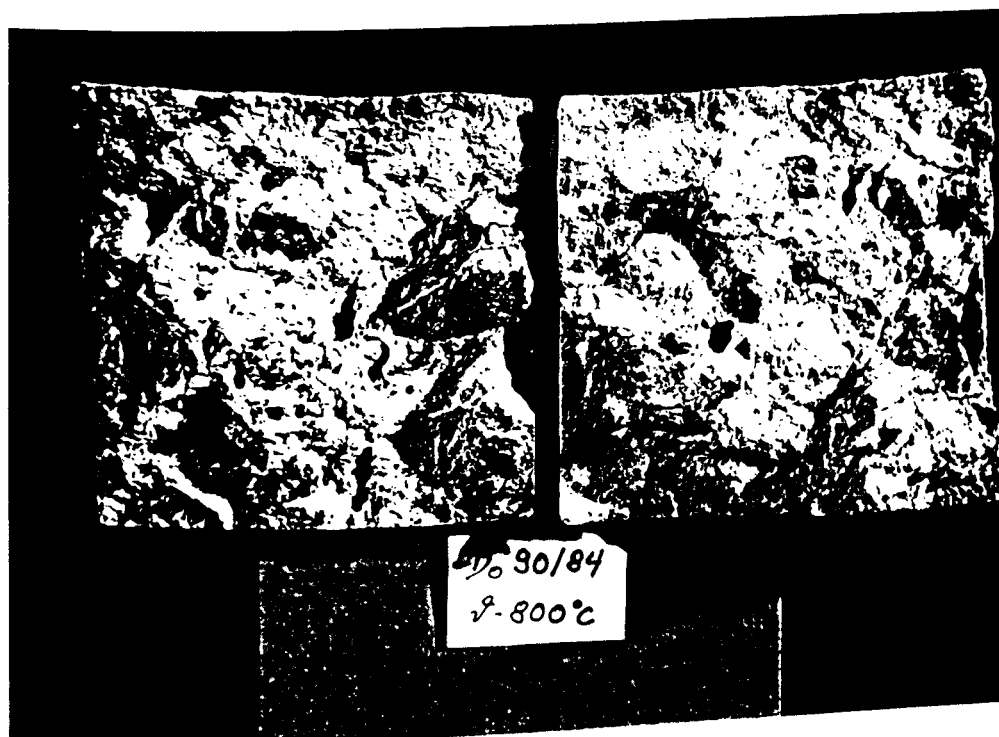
Bruchfläche eines bei 800 °C geprüften, unbewehrten Diabasbetonprobekörpers
